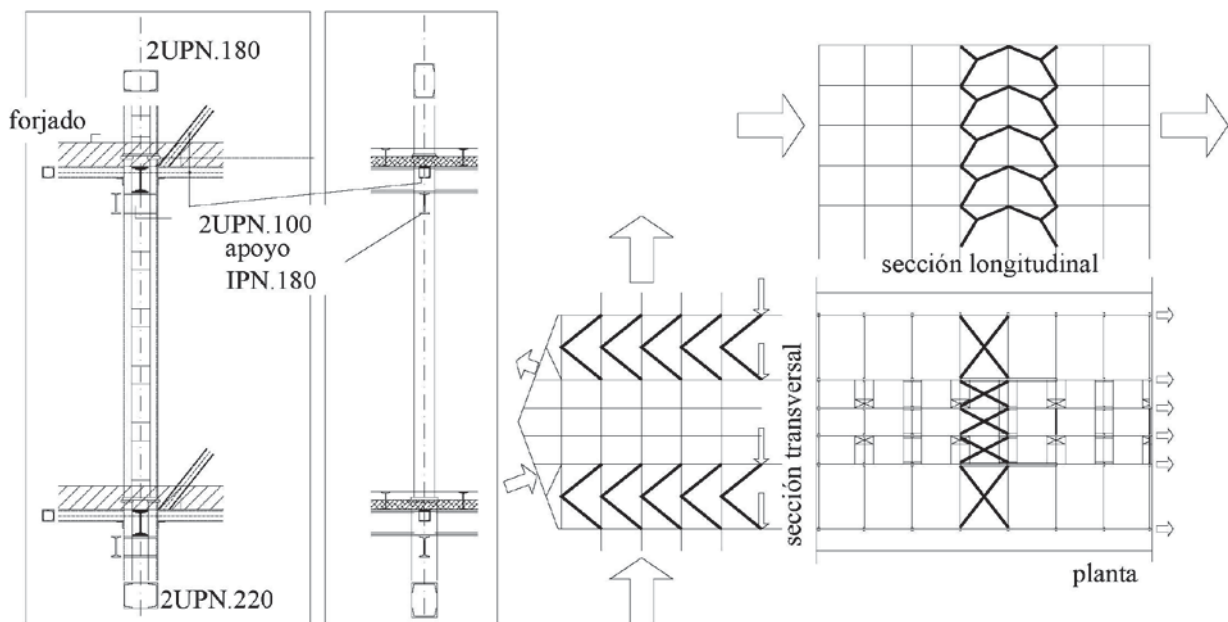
Detalles redibujados de pilares y vigas. Esquemas estructurales.
